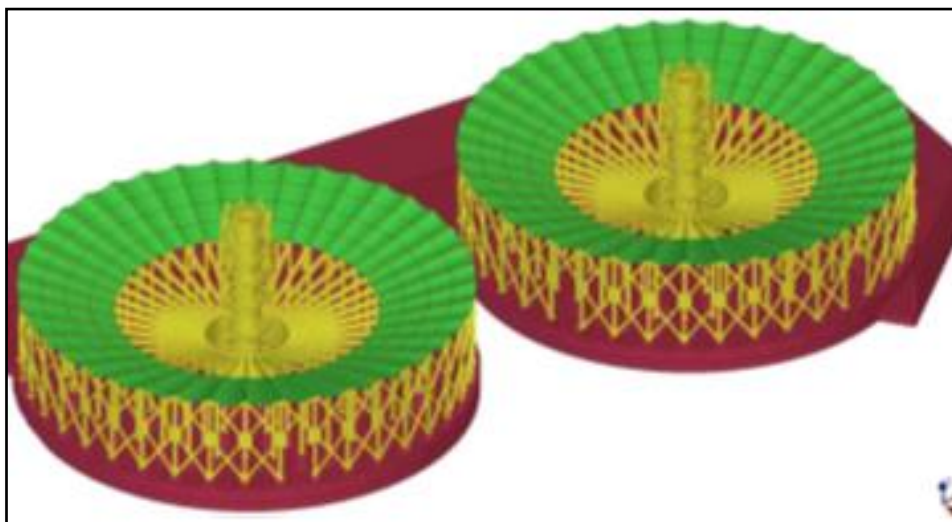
Vista CAD de Planchas de fondo tipo 1
